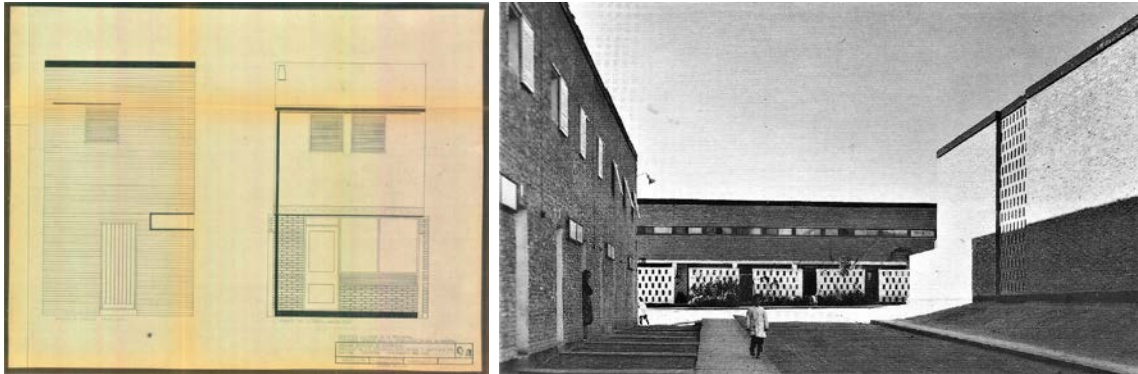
(izda.). 1ª Fase, Plano 9a, Vivienda tipo A, Detalle de fachadas, Madrid 1956.
